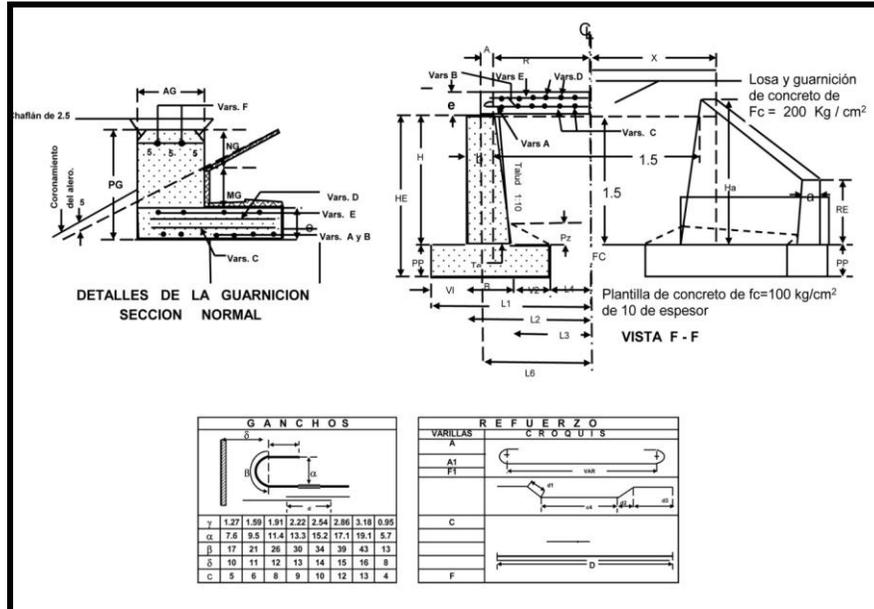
“ALCANTARILLA DE LOSA 1.5 x 1.5 m
